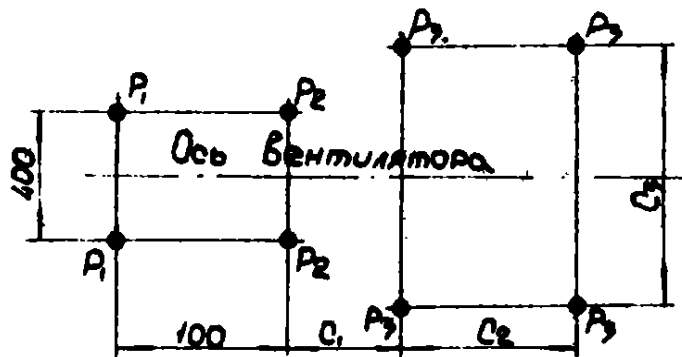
Схема распределения нагрузки на опоры от дутьевых вентиляторов типа ВД-6, ВД-8, ВД-10, ВД-12
